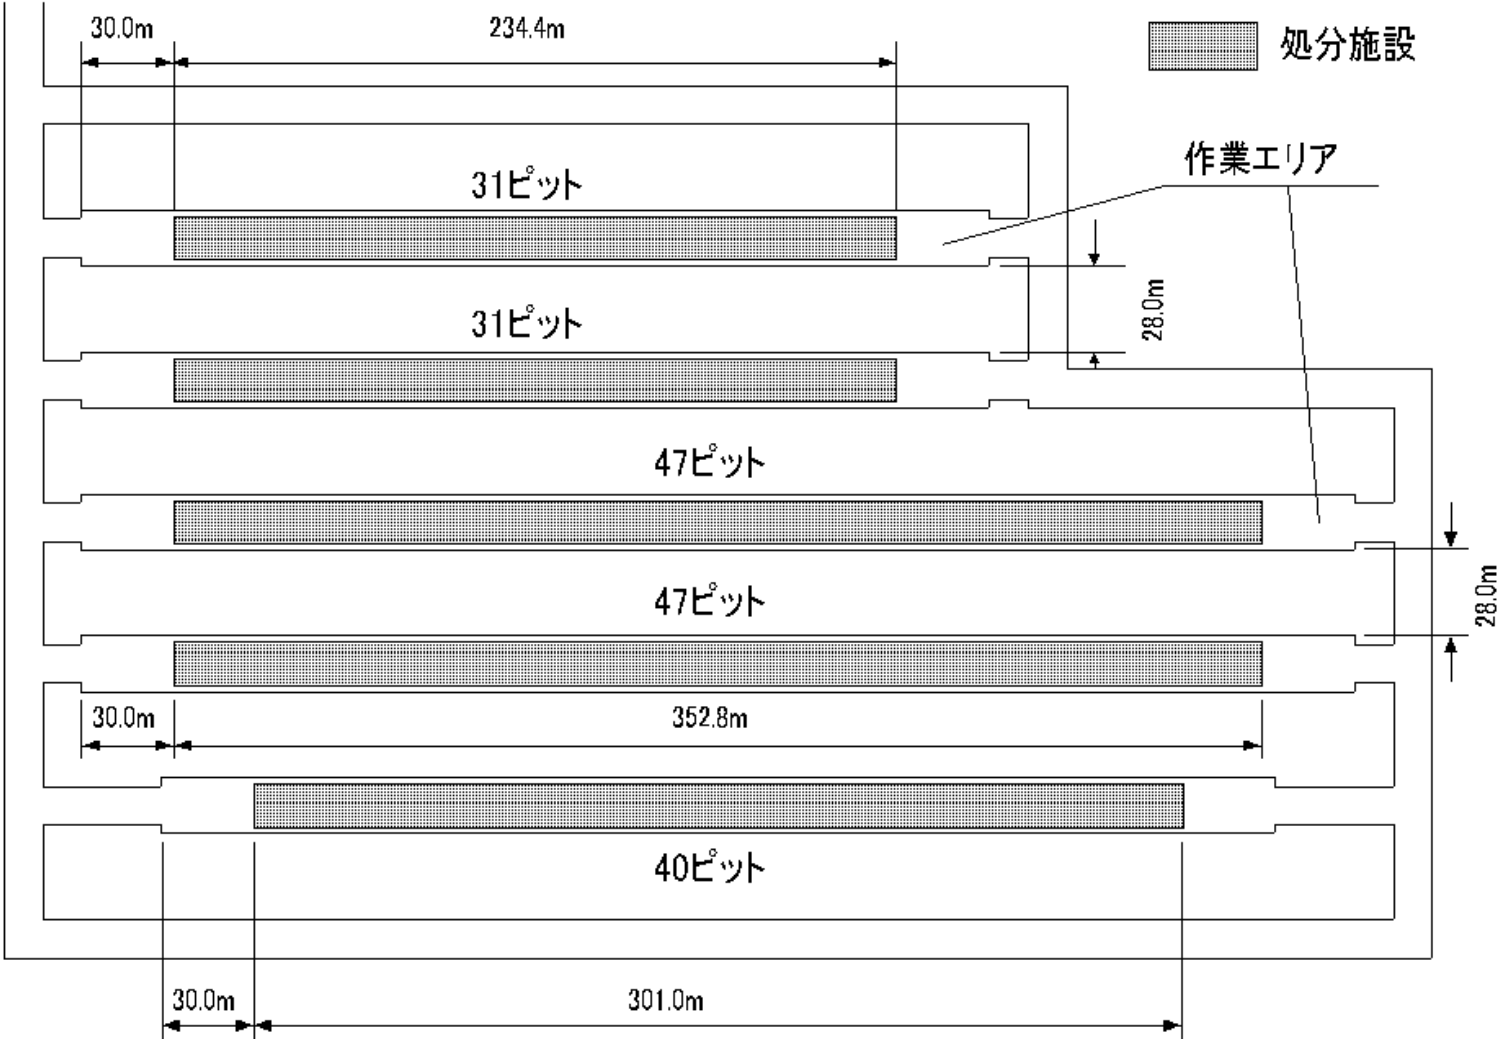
ケース2(増設)のトンネル型施設配置図
